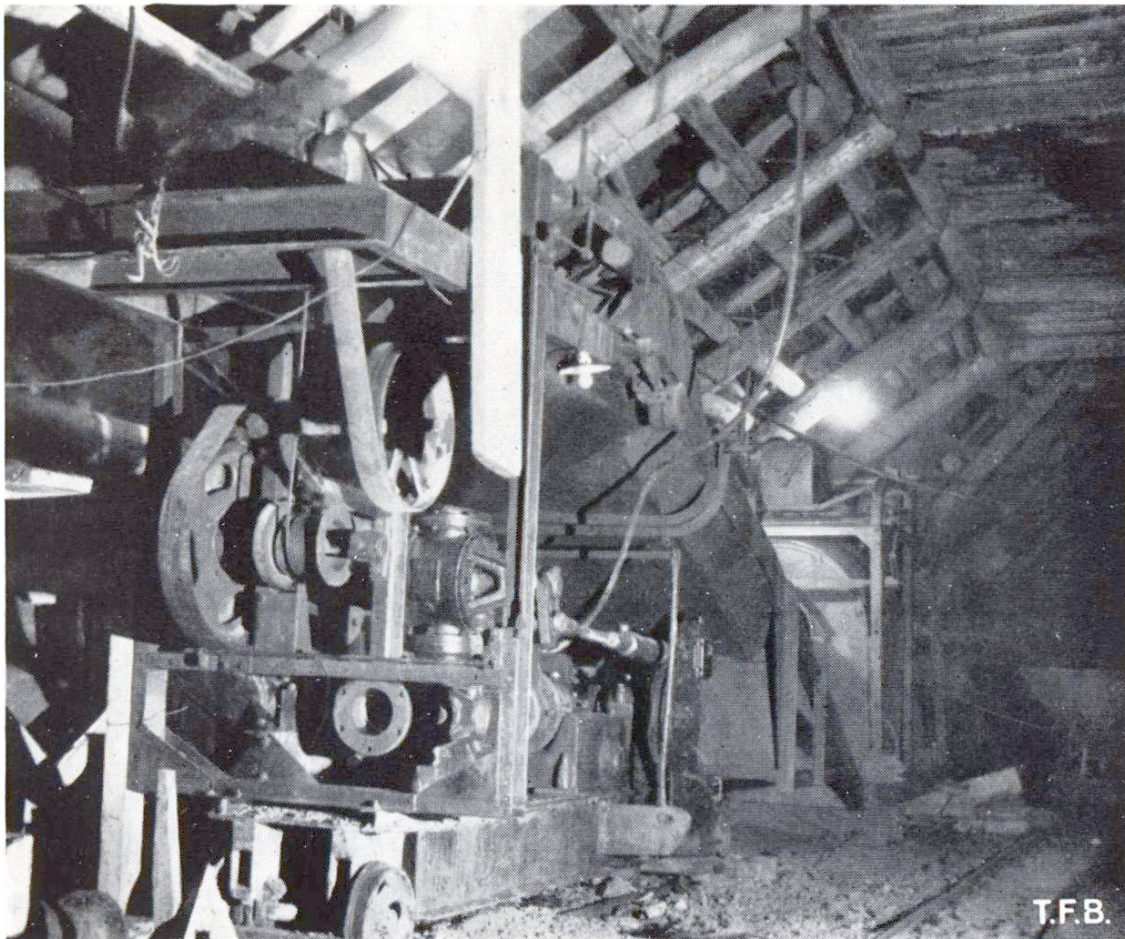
Betonmaschine (im Hintergrund), Betonpumpe (im Vordergrund), dazwischen Beton-aufzug
